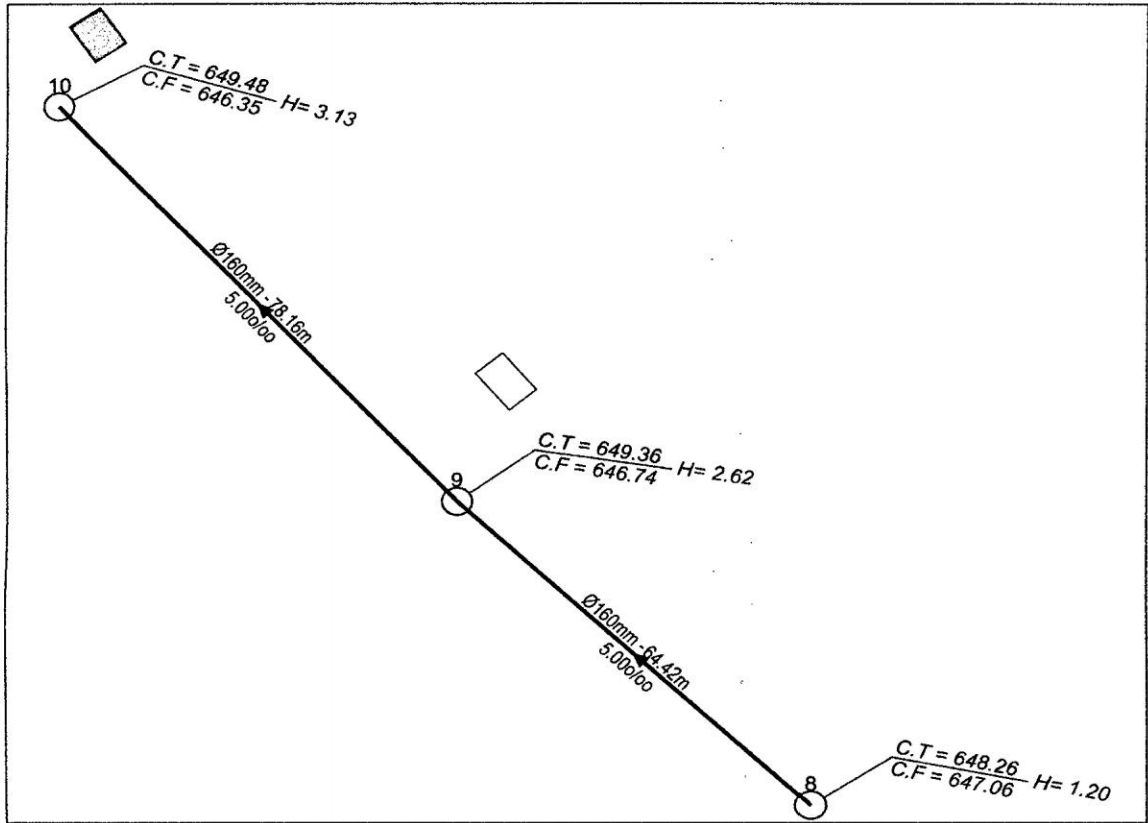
Plano en planta y diagrama de flujo del buzón N° 8 a 10. Fuente:
